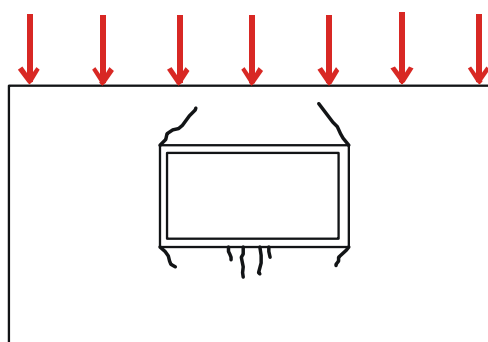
fissuração teórica em torno de abertura em parede submetida a sobrecarga (THOMAZ, 1989)
